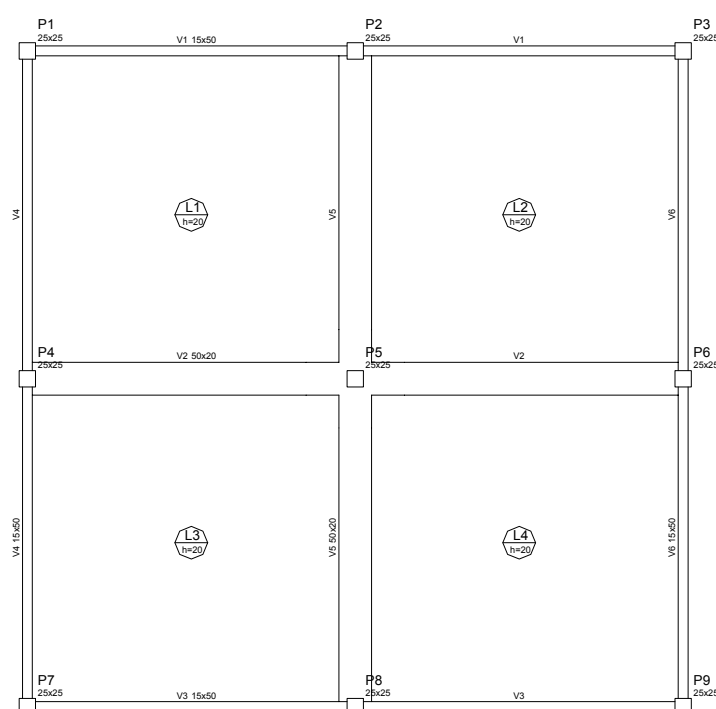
Planta de fôrmas do modelo rodado no AltoQI Eberick para simular laje plana.
